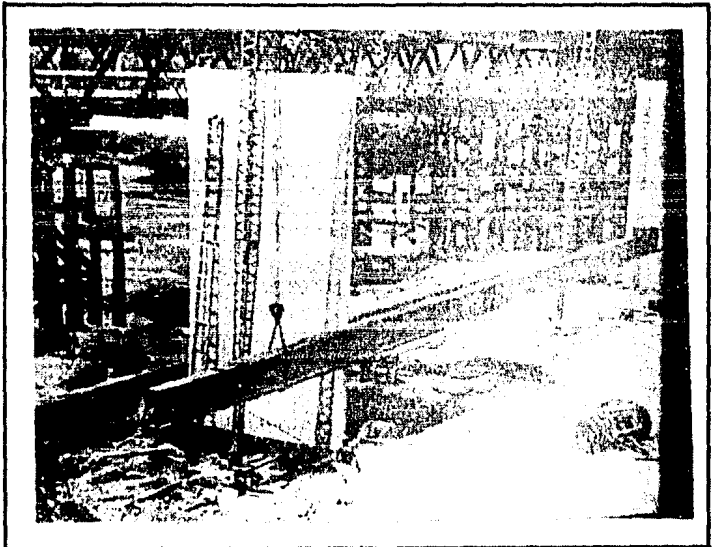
MONTAJE DE UNA TRABE, MEDIANTE EL SISTEMA DE LANZAMIENTO CON CABLE VIA. ESTE SUSPENDE UN EXTREMO DE LA TRABE, MIENTRAS QUE EL OTRO ES IZADO Y EMPUJADO MEDIANTE UNA GRUA.
